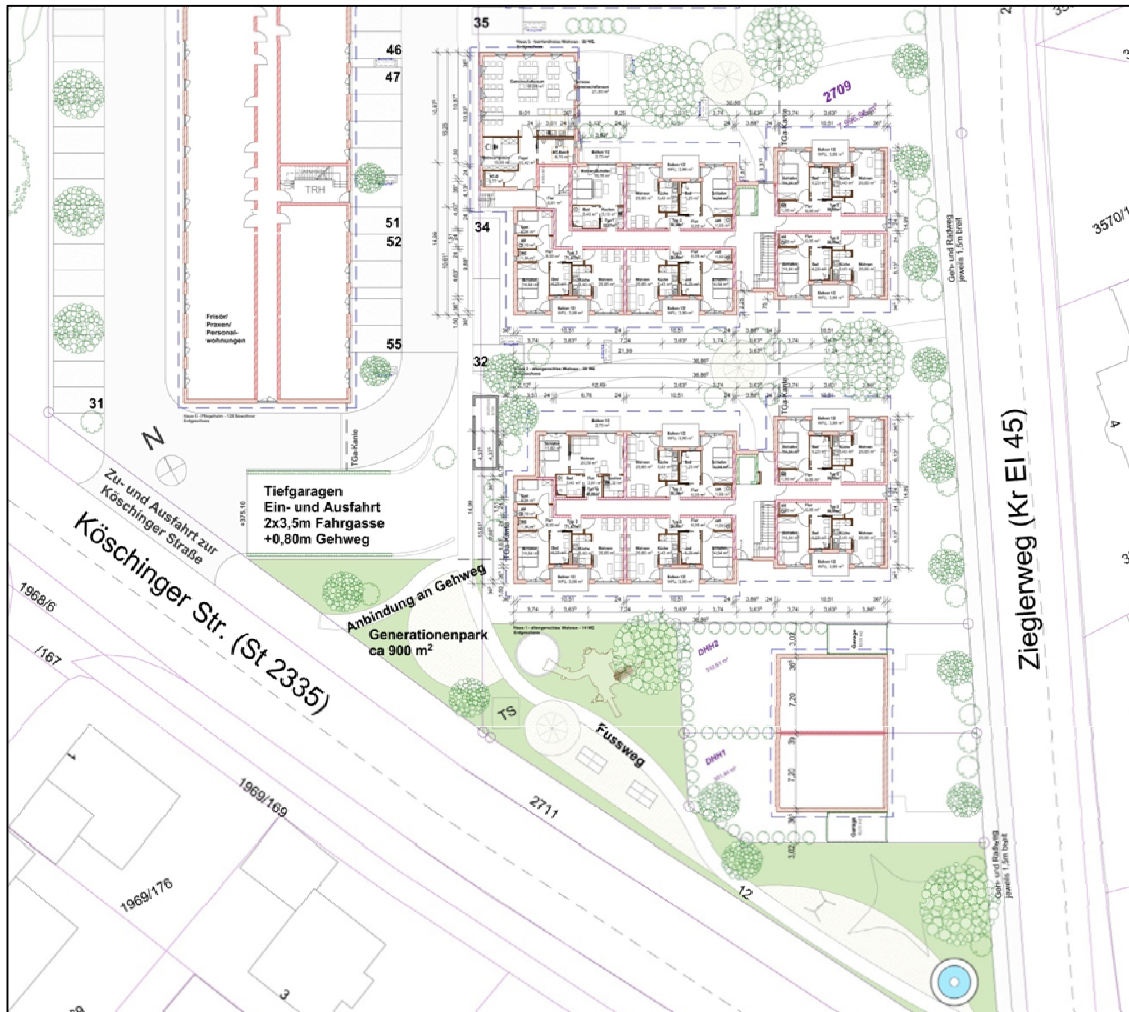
Grundriss Erdgeschoss, südlicher Teilbereich (Haus 1, Haus 2, Haus 6, Haus 7) /66/
